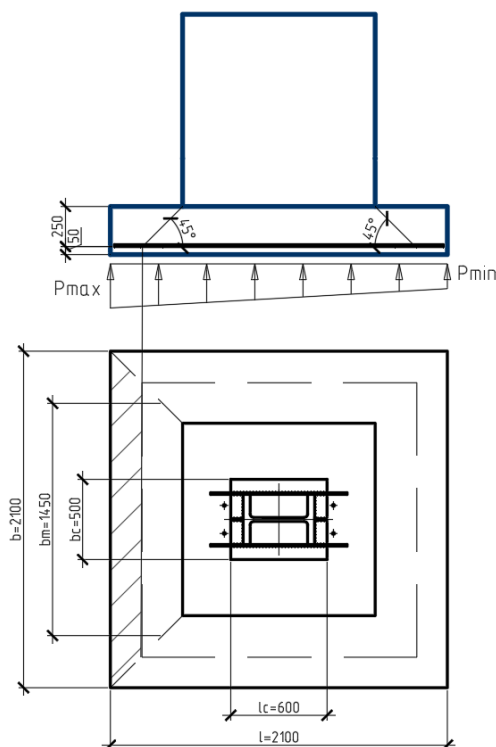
Схема к расчету низкого фундамента на продавливание
